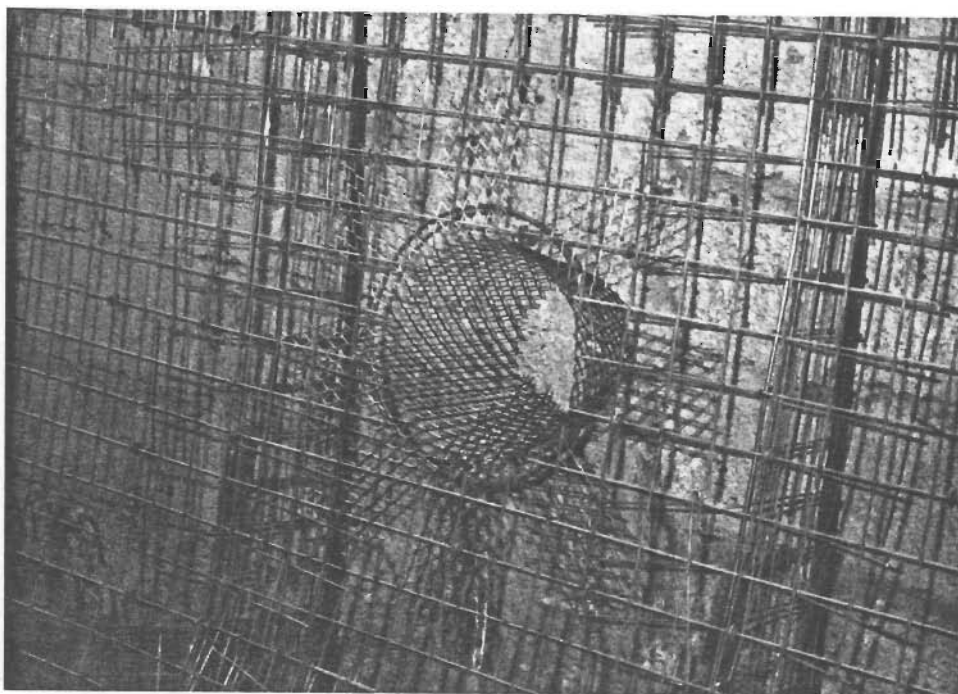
Armação de peça que utiliza tela soldada e de metal expandido.
